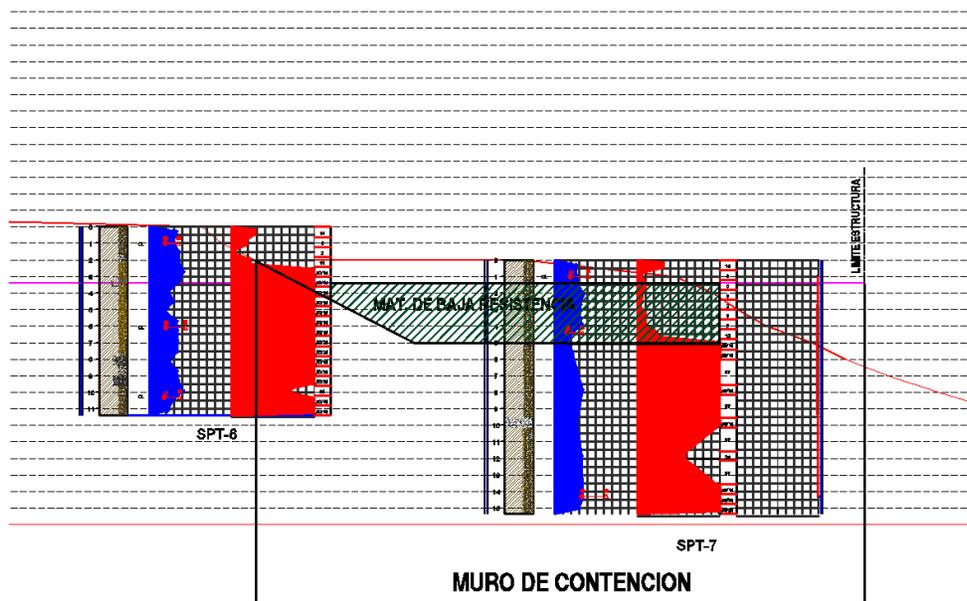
REQUERIMIENTO DE MUROS DE CONTENCION CORTE E - B
